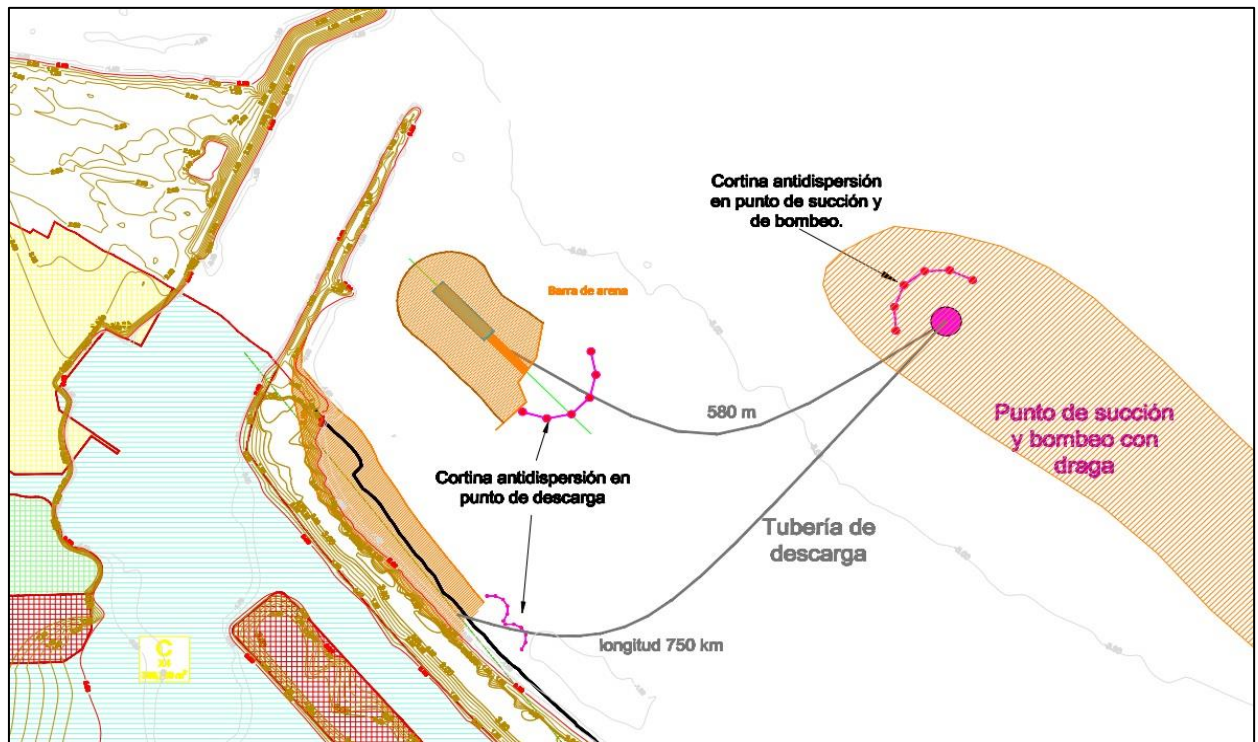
Ejemplo de la instalación de tubería flexible y de las cortinas anti-dispersión en zona M1.
